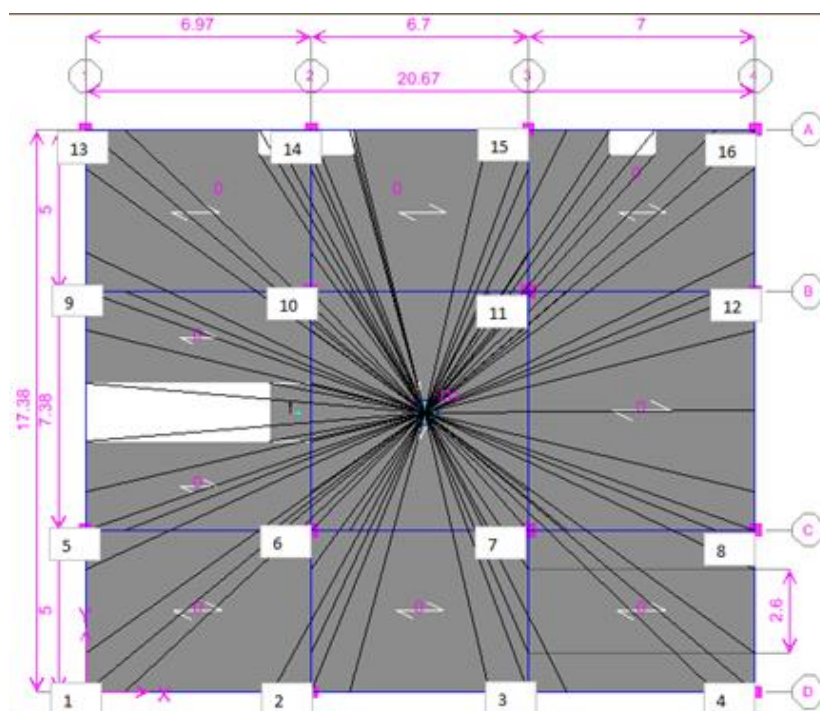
Localización de aisladores en planta para cálculo de la rigidez torsional en planta
